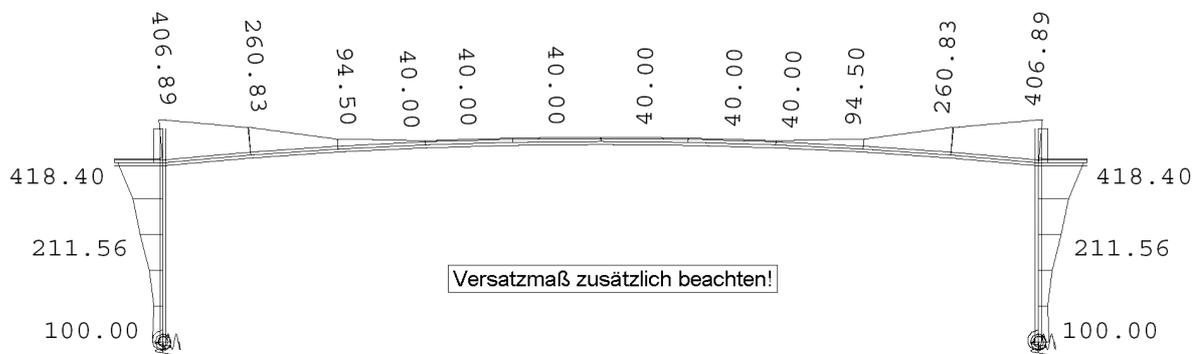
erforderliche Bewehrung zur Begrenzung der Rissbreite, Rang 2 („oben“ bzw. außen)
